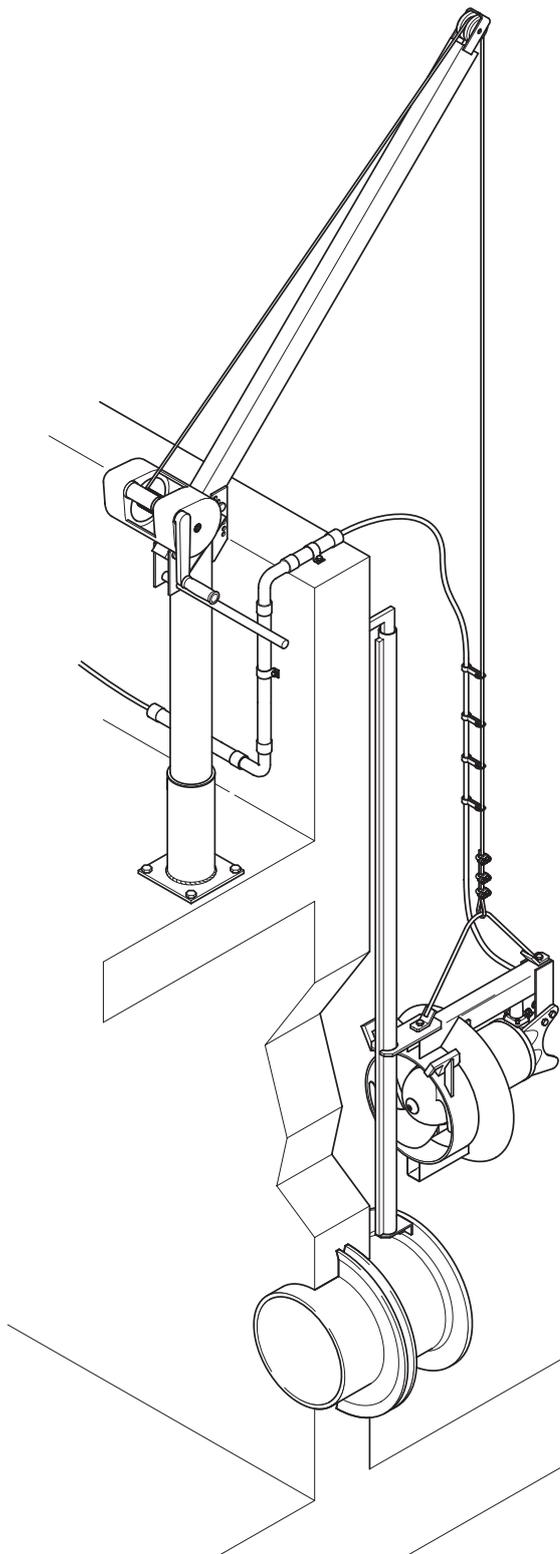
Esempi d'installazione con dispositivo di sollevamento Sulzer 5 kN
